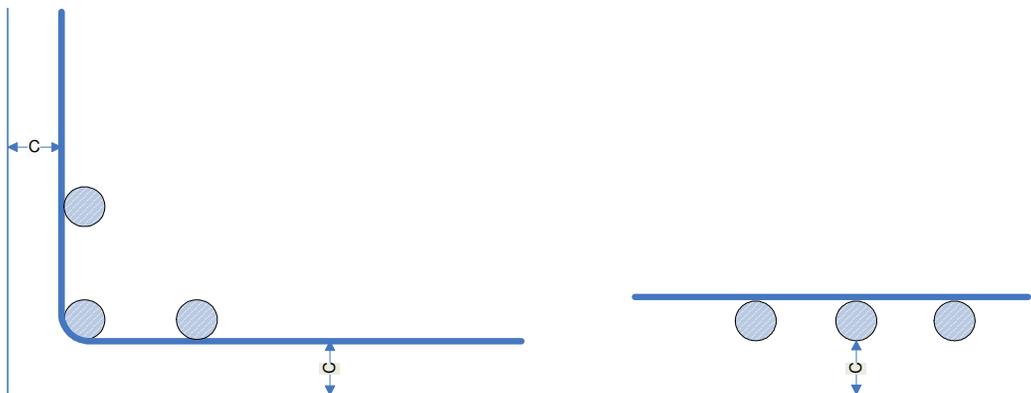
Exemplo de camada de cobertura (espessura "c"). Fonte: FUSCO (1995)
